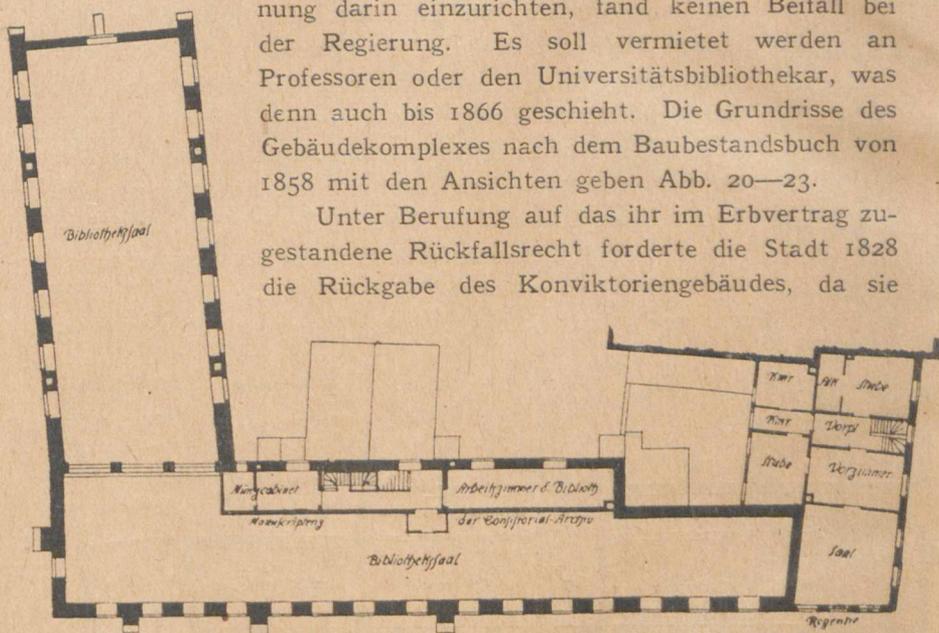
Weißes Kolleg 1858. Obergeschoß 1 : 400
